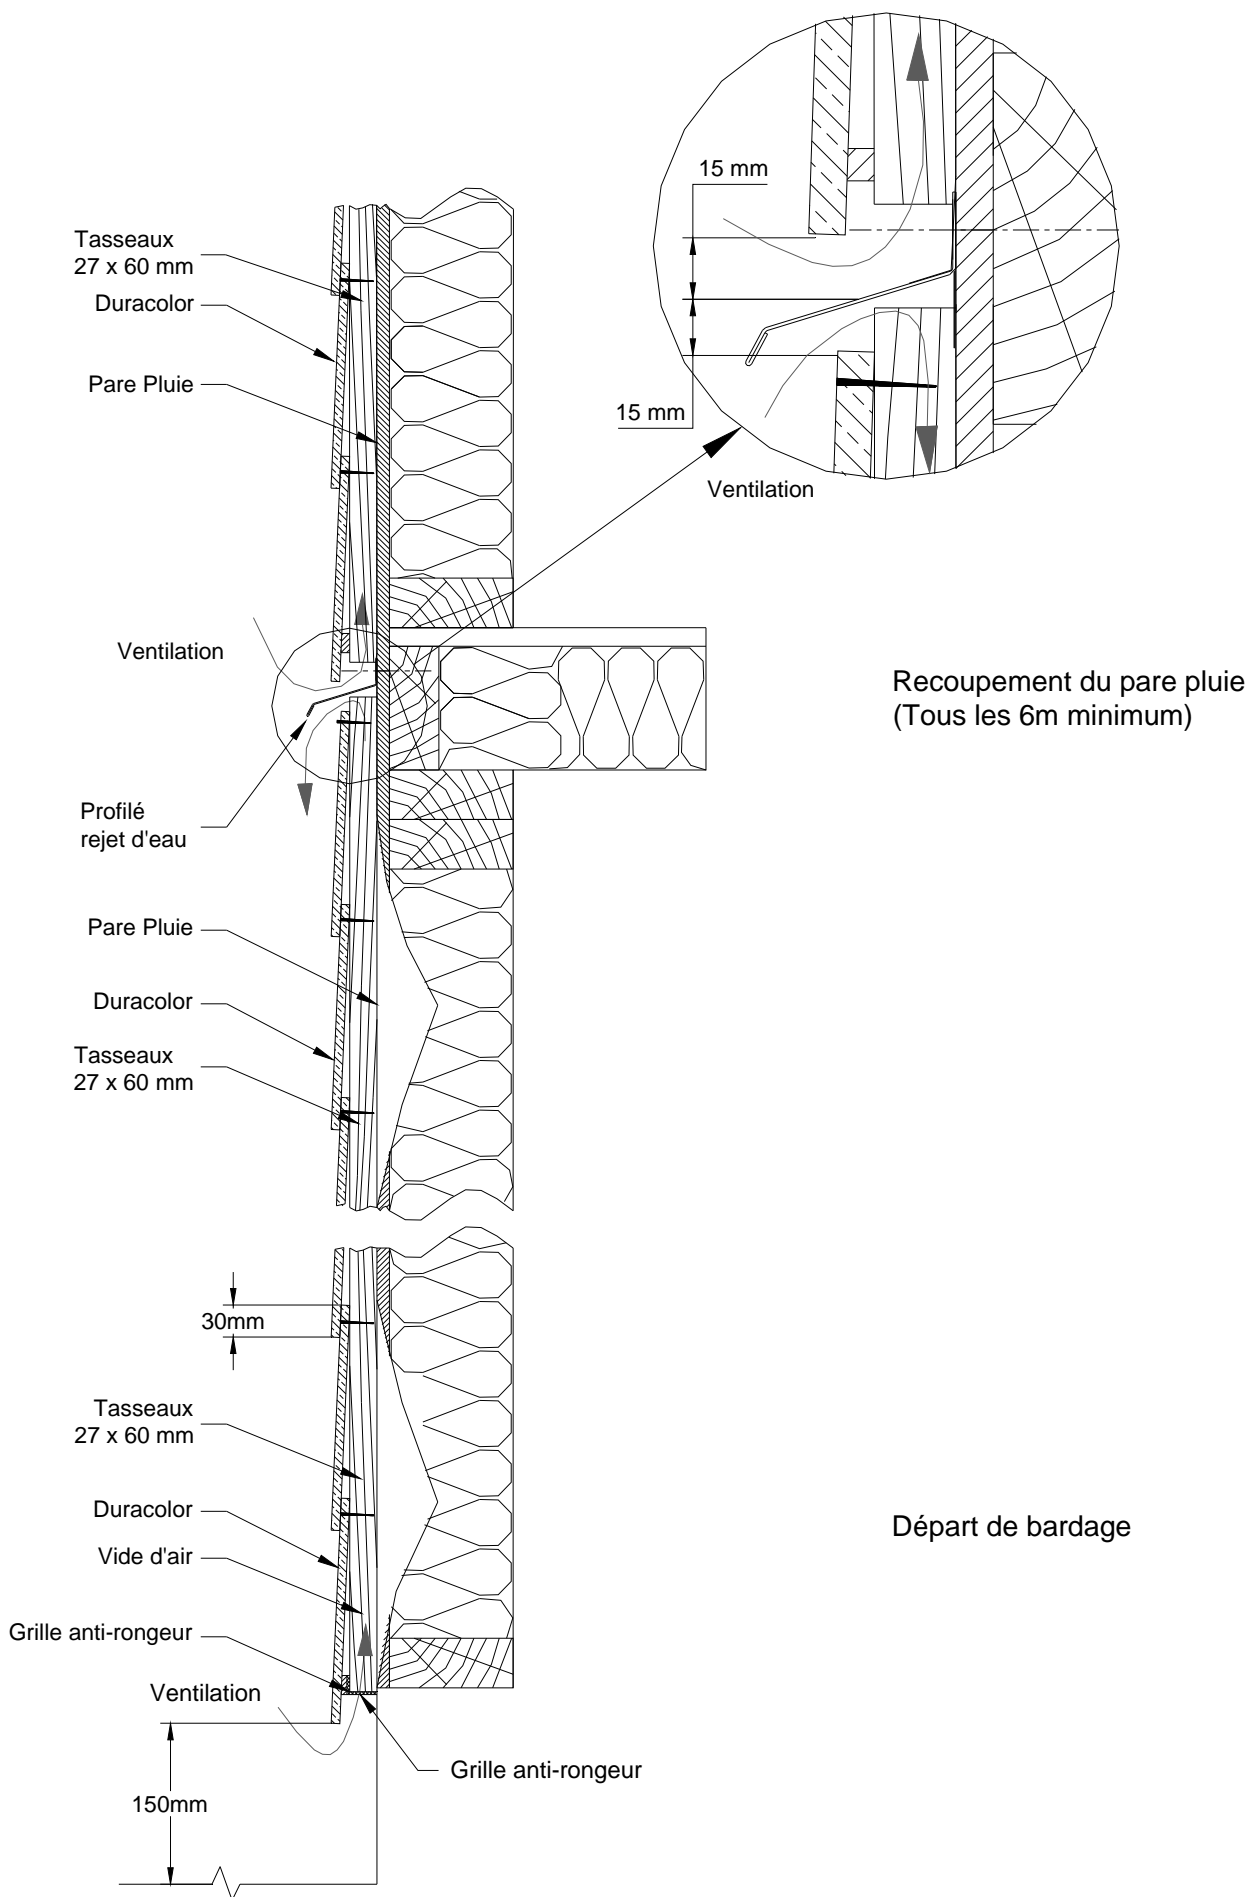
Coupe verticale sur MOB – Départ de bardage
